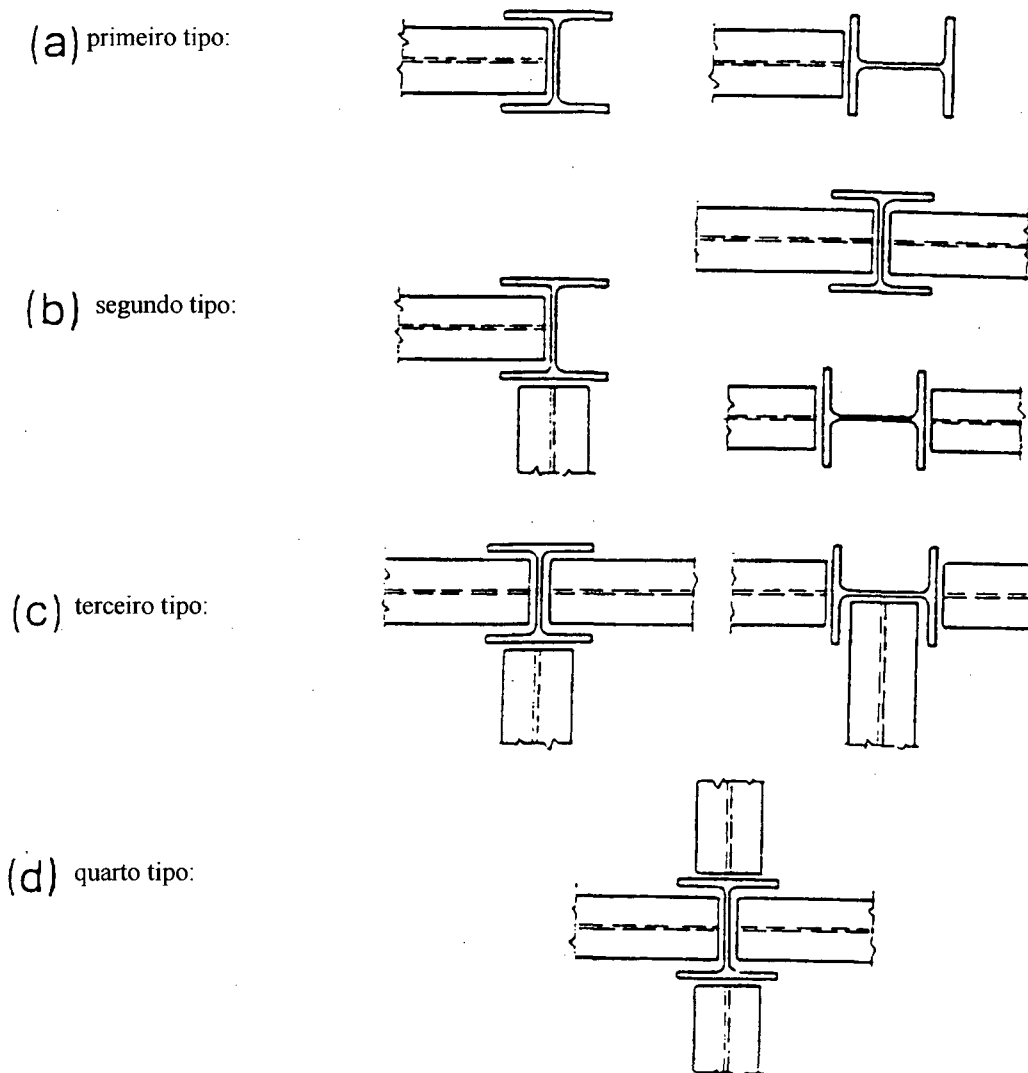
Tipos de arranjos das ligações entre viga e pilar, retirado de Kirby et al (1996).
